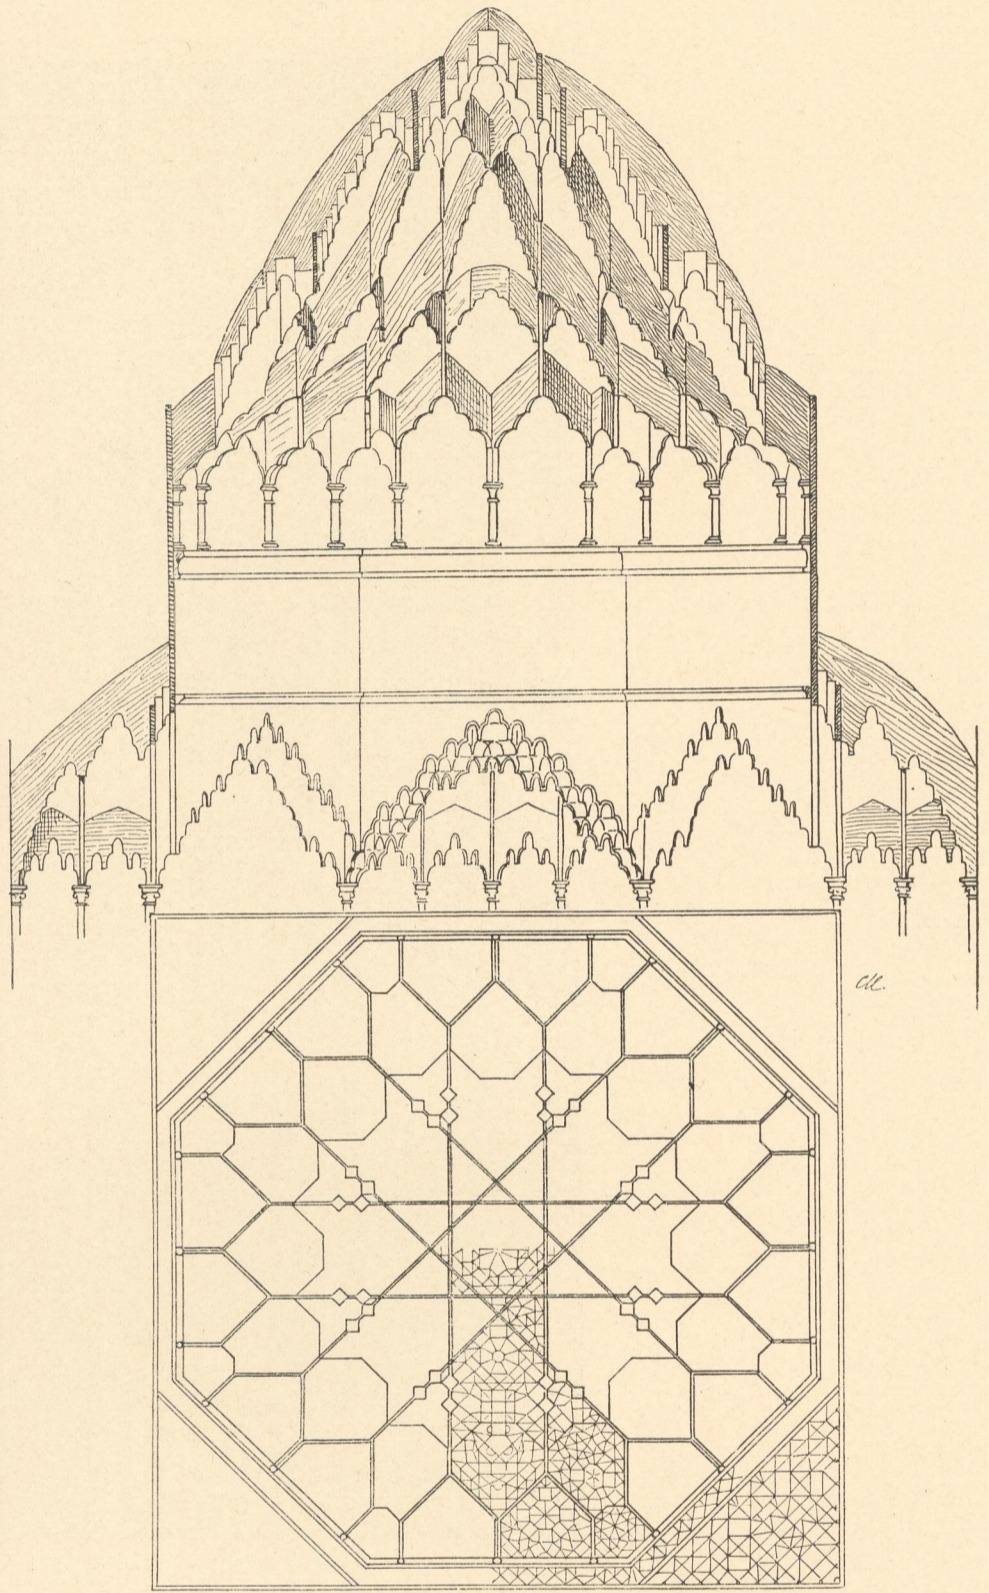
Grundriss und Diagonalschnitt zum Bohlengeruest des Stalactitengewelbes
